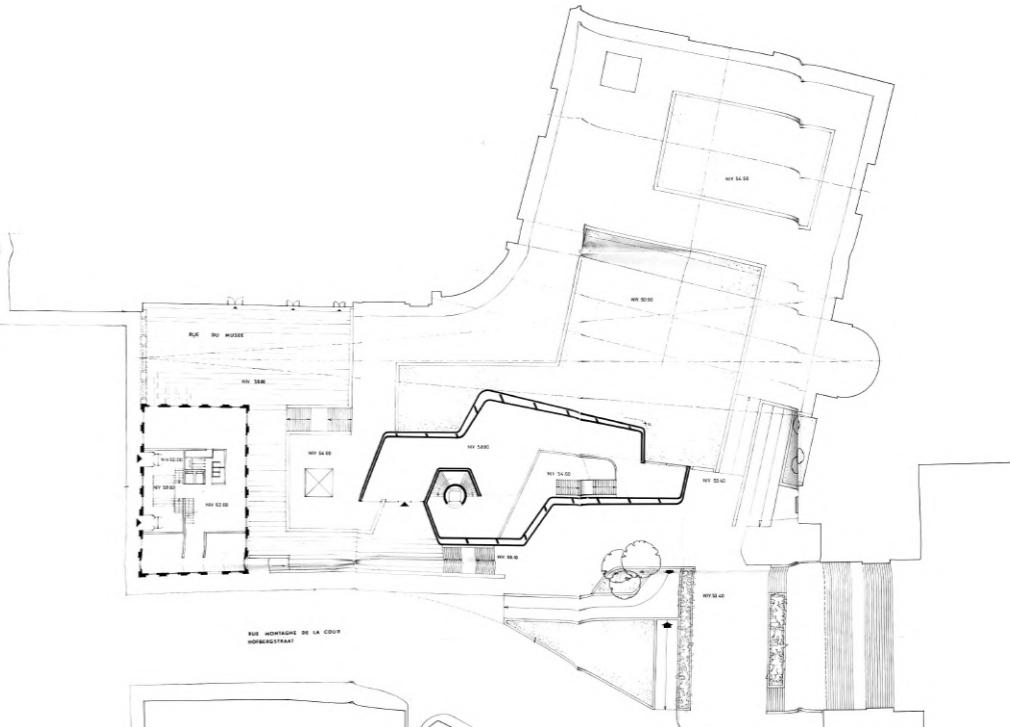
Plan R0, 6^{ème} esquisse v4.
